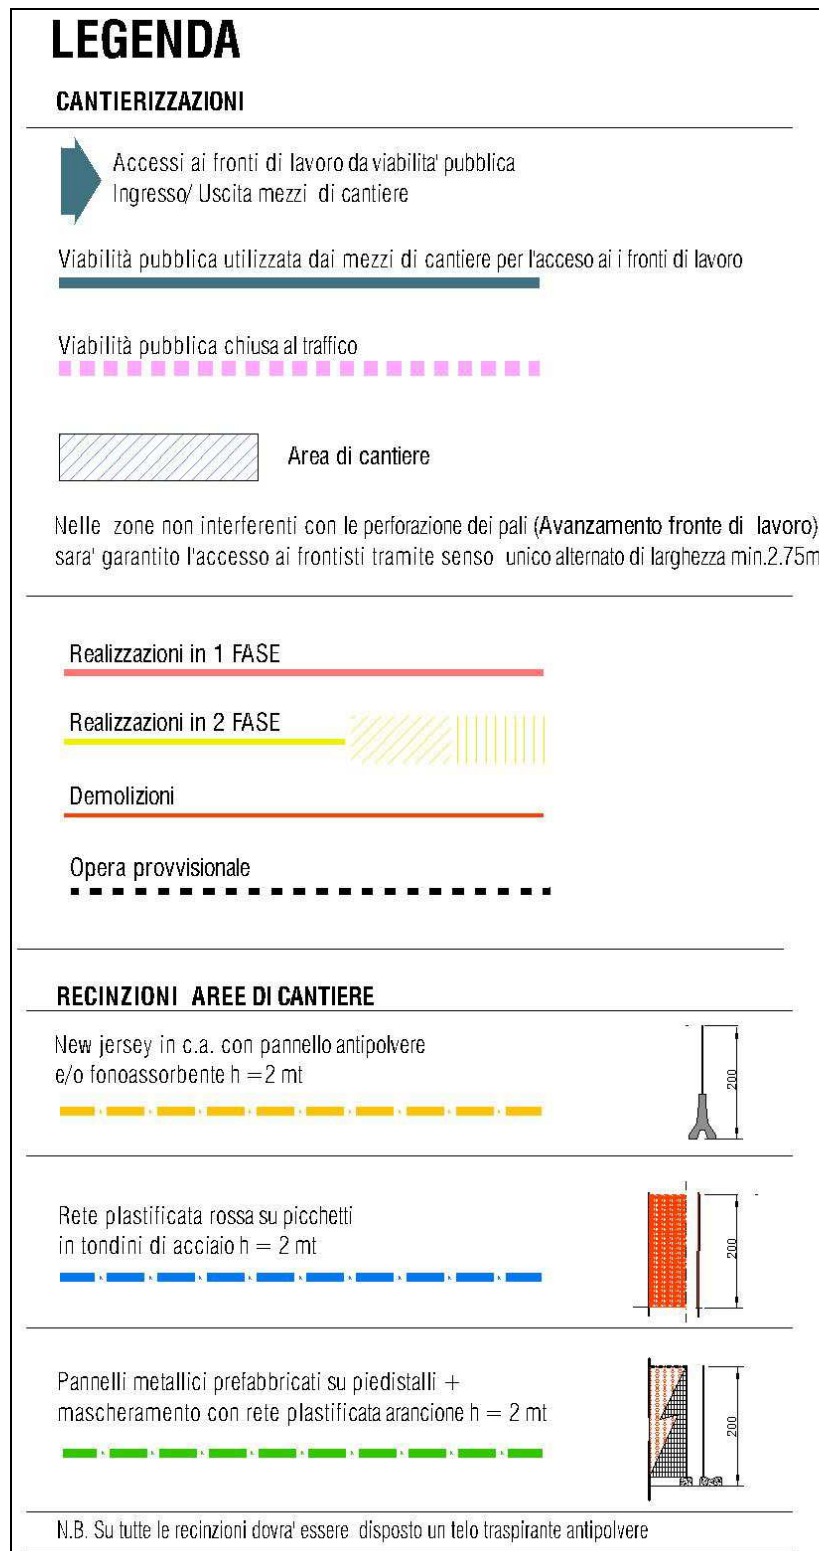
Estratto legenda apprestamenti e recinzioni fasi cantierizzazione
